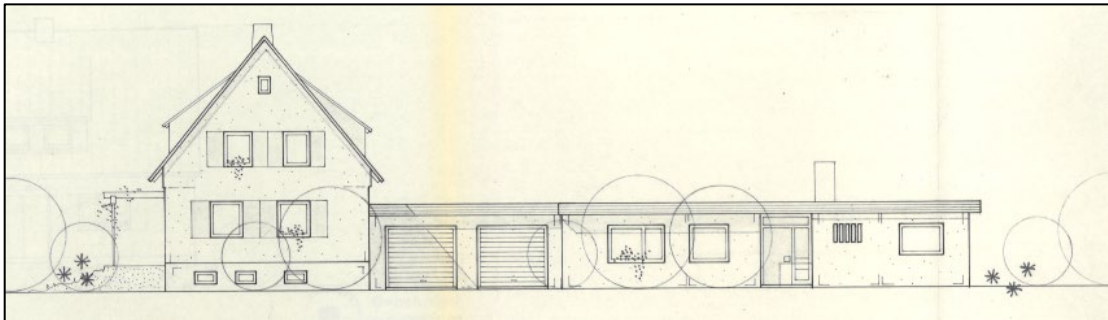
Wohnhaus- und Garagenanbau (Kirchh. Str. 102) an bestehendes Wohnhaus (Kirchh. Str. 100), Ost-Ansicht, Entwurf: Freie Architekten H. Schippert & J. Harms (1971), ohne Maßstab
